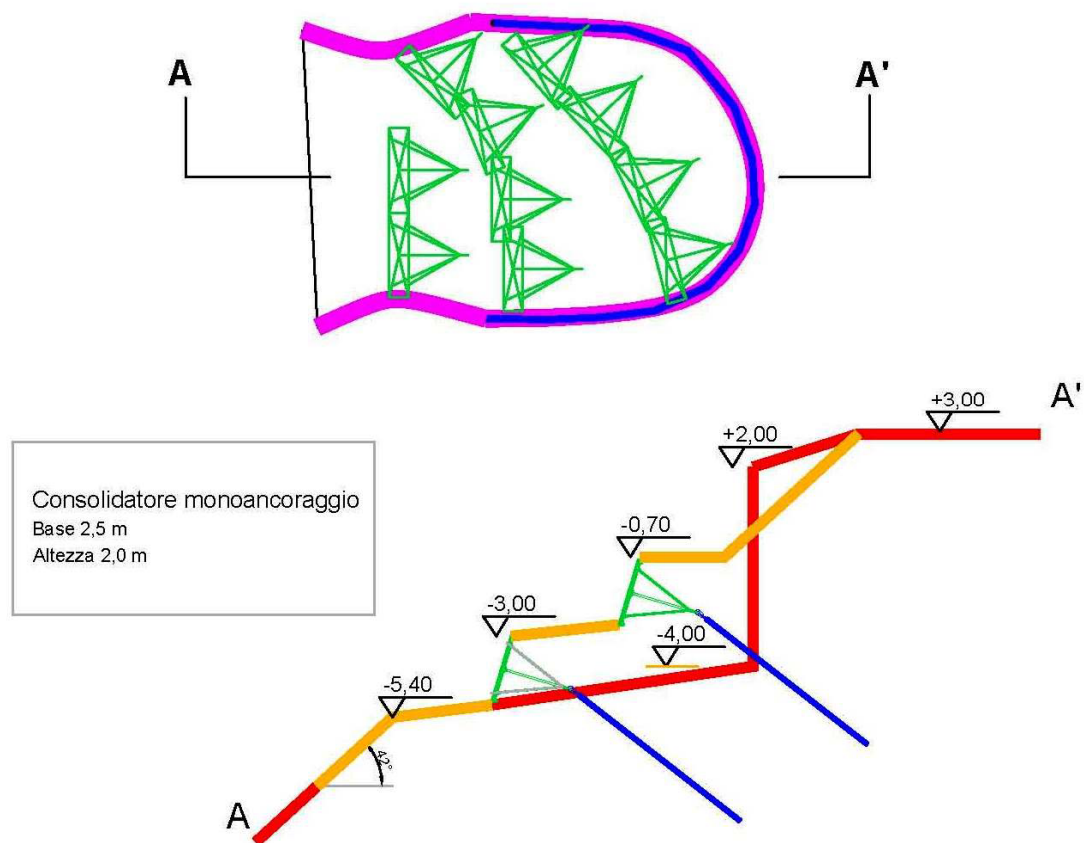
e 2 – Pianta e sezione dell'intervento di ricostruzione del versante
